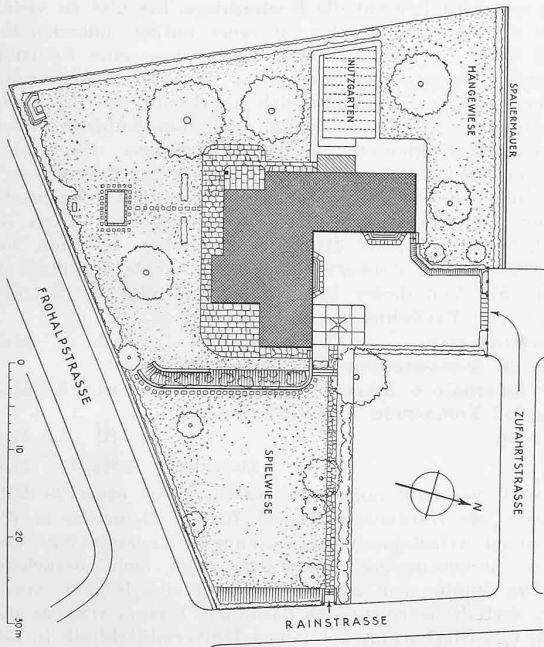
Lageplan 1:800, gleich orientiert wie Abb. 5 und 9, daher gegenüber den Grundrissen um 90° verdreht!
